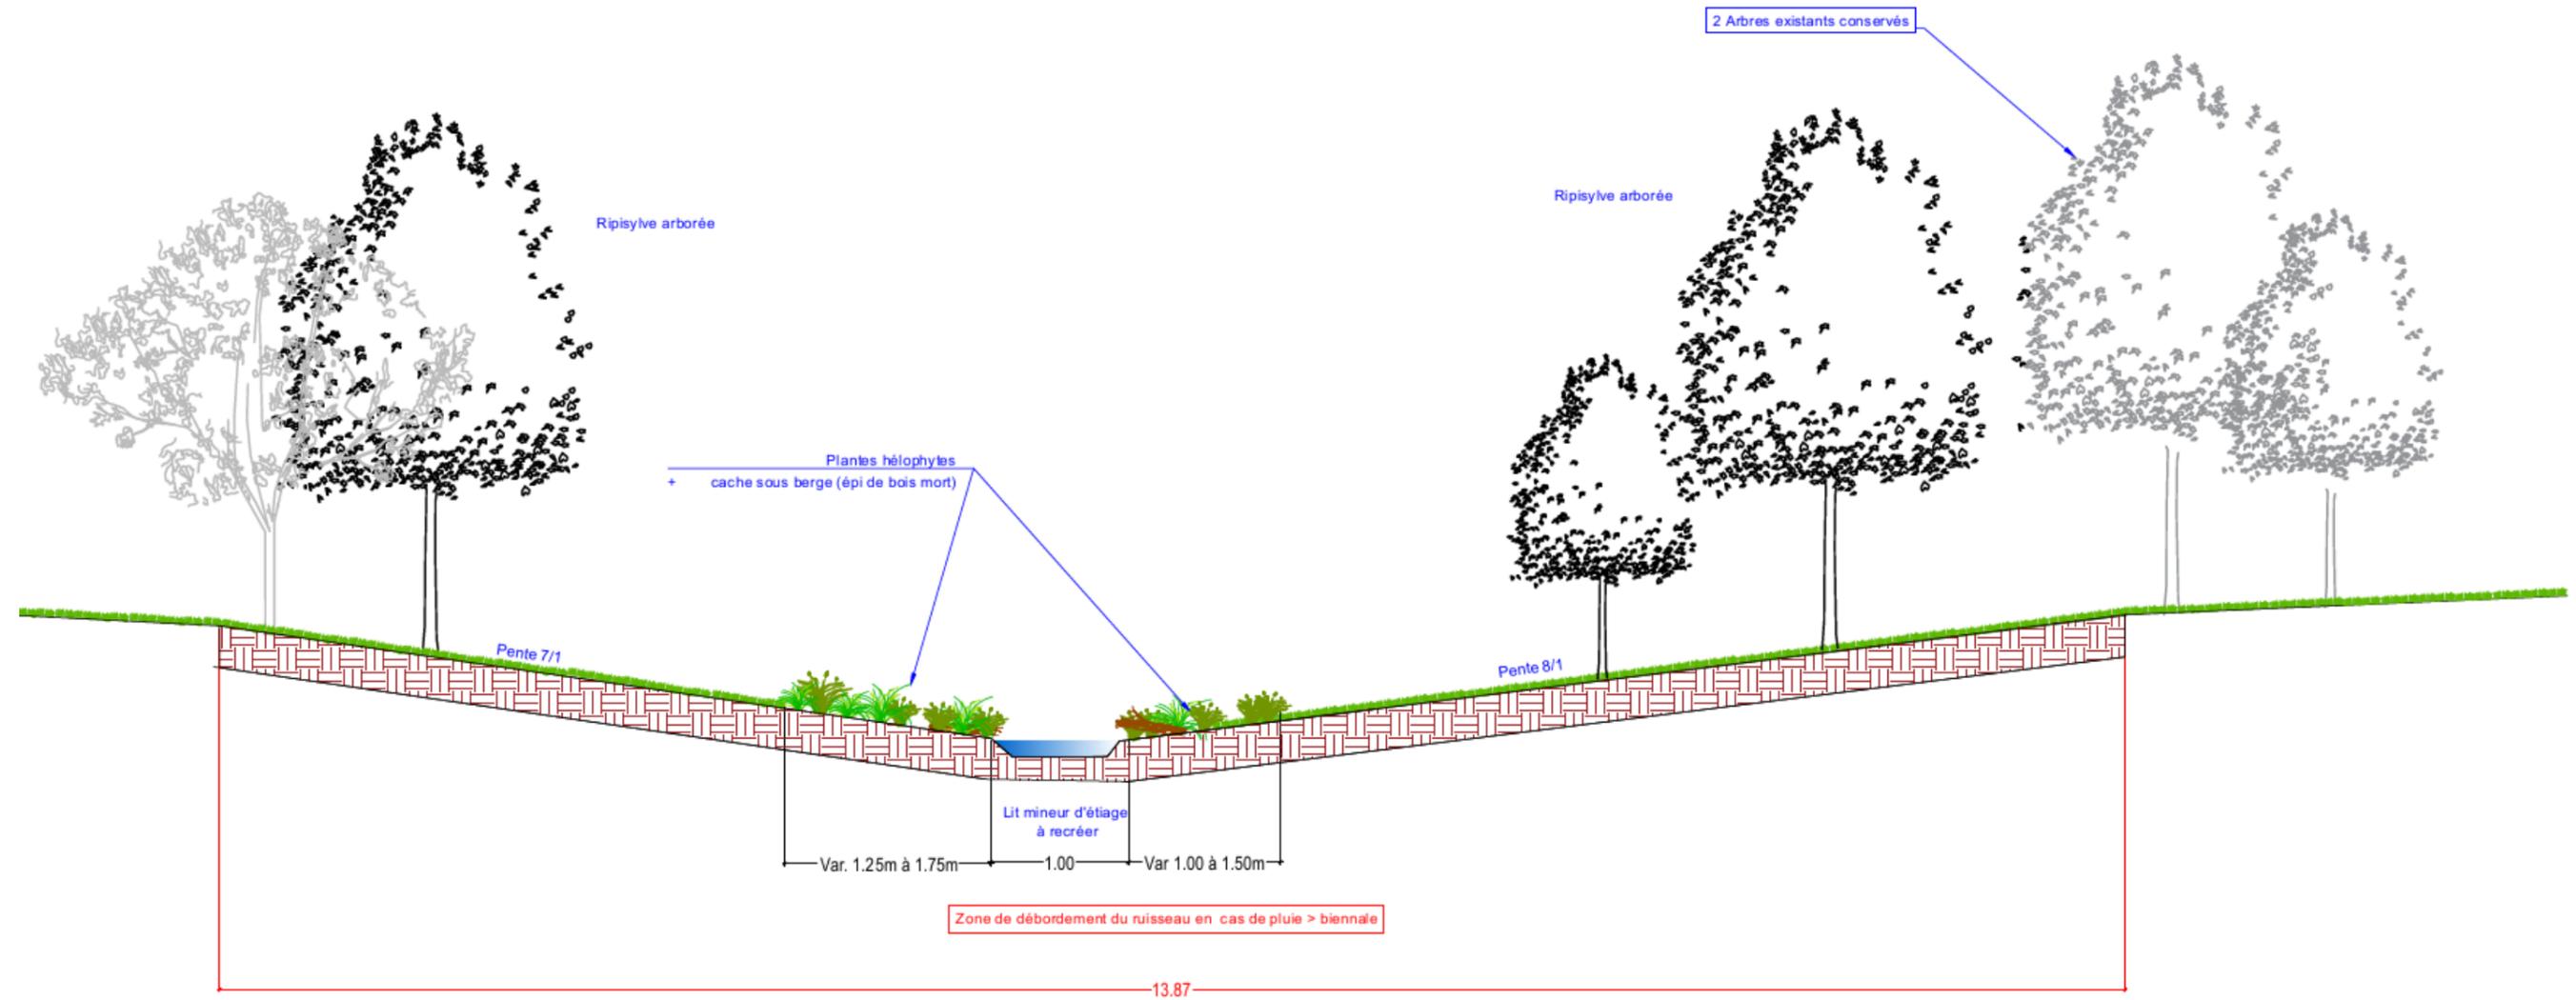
REMEANDRAGE DU RUISSEAU PREVU DANS LE CADRE DU PROJET – COUPE AA'
